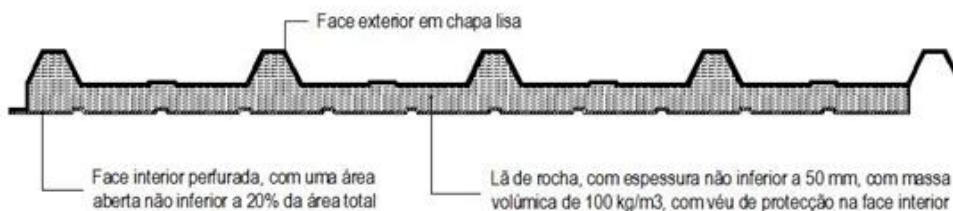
Painel sanduíche utilizado no pavilhão desportivo.
